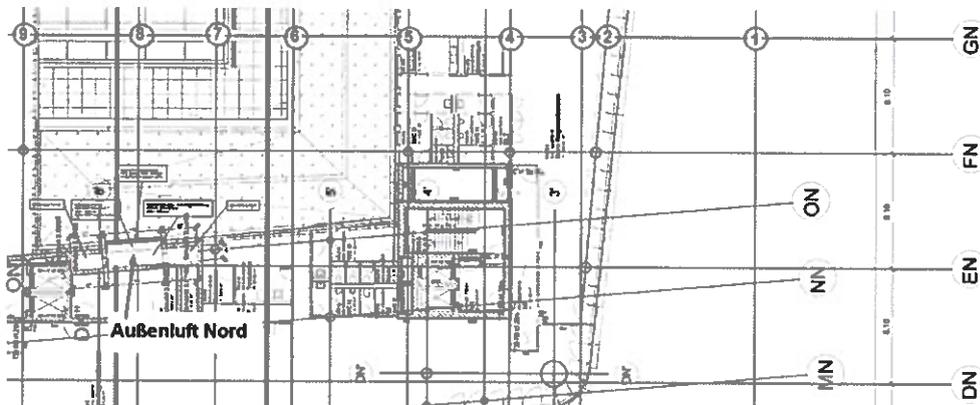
Schachtposition Ebene +3 (Grundriss, Ausschnitt) [1]
